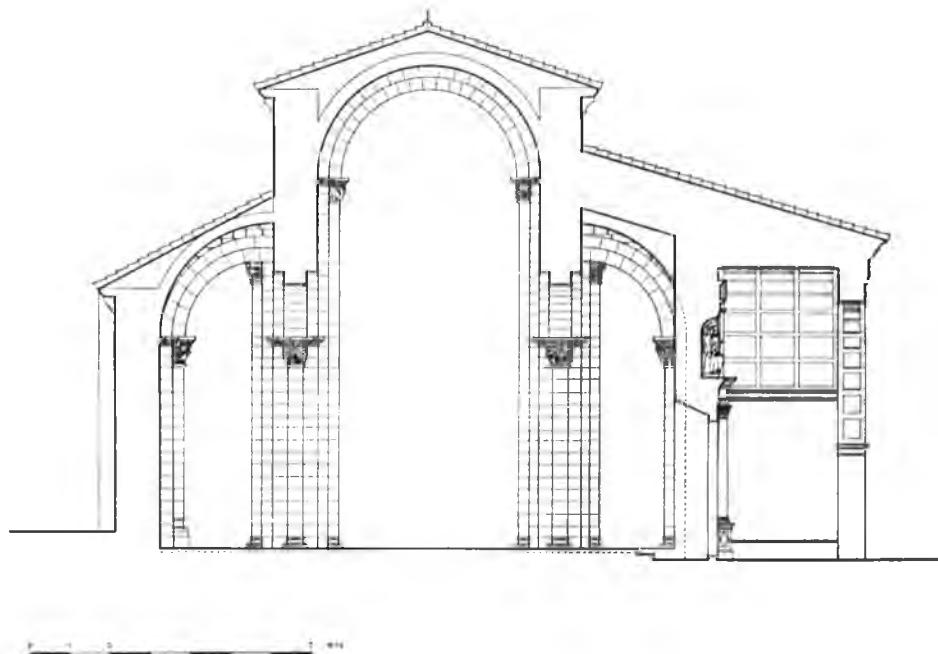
Iglesia parroquial de San Pedro, en Aibar; sección transversal.
